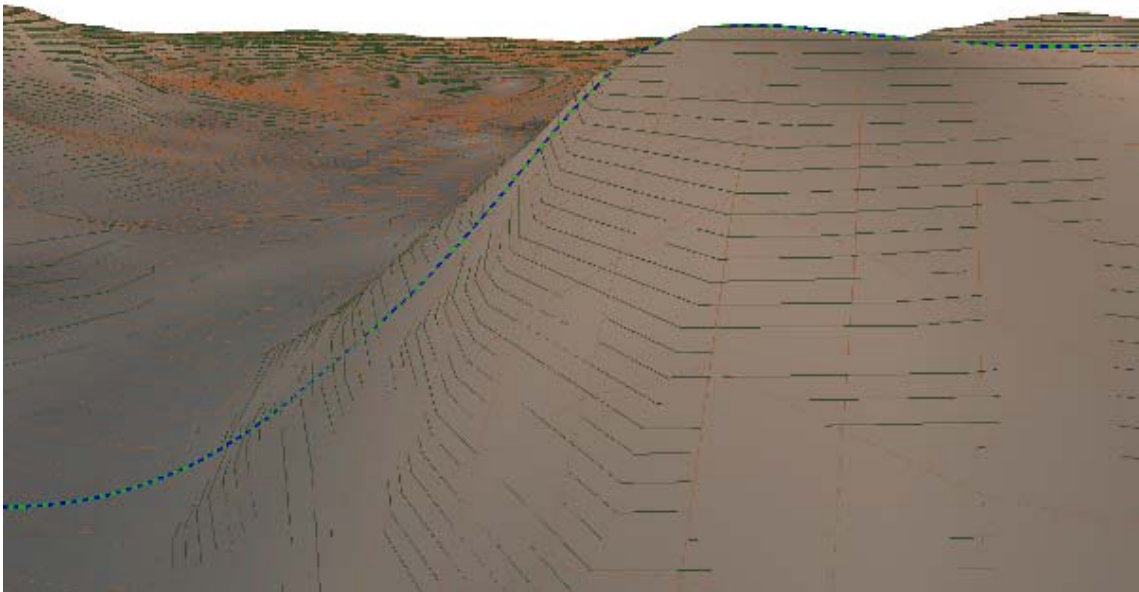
Configuração final apoiada – visão da subida do planalto – duto 8”
